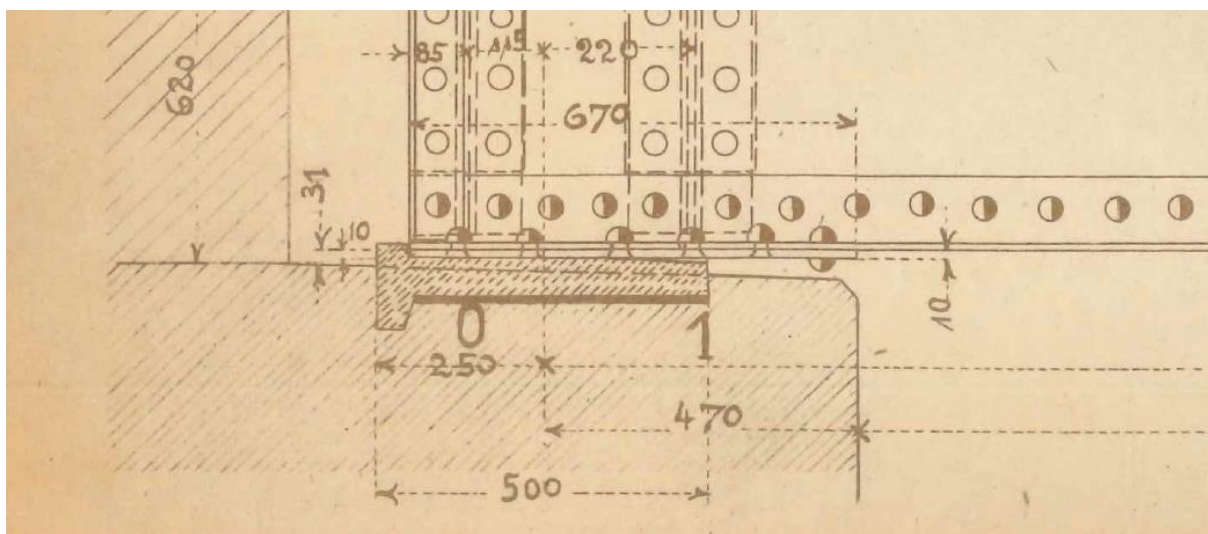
Půdorys vč. ztužení a změny geometrie podélníků, archivní dokumentace
